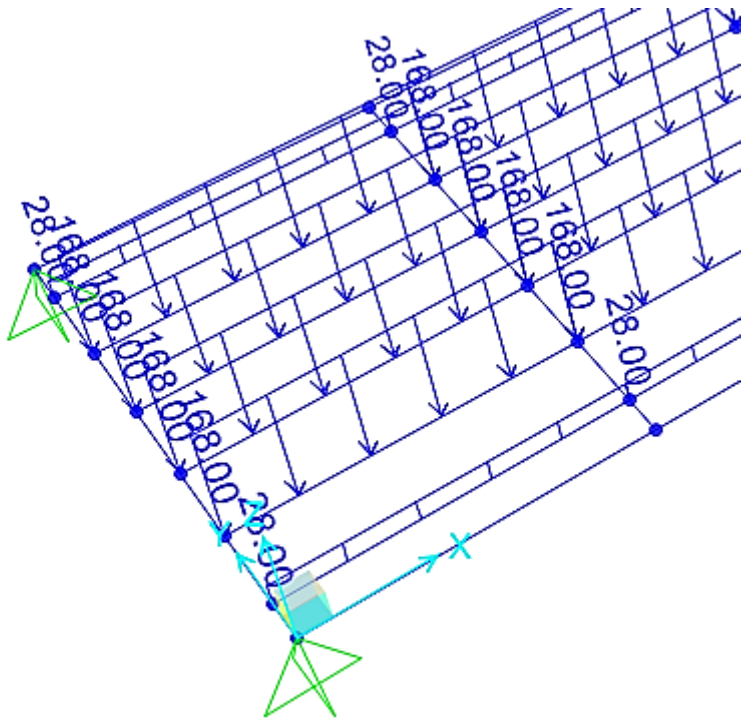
Profil WF Gelagar melintang atas & ikatan angin
